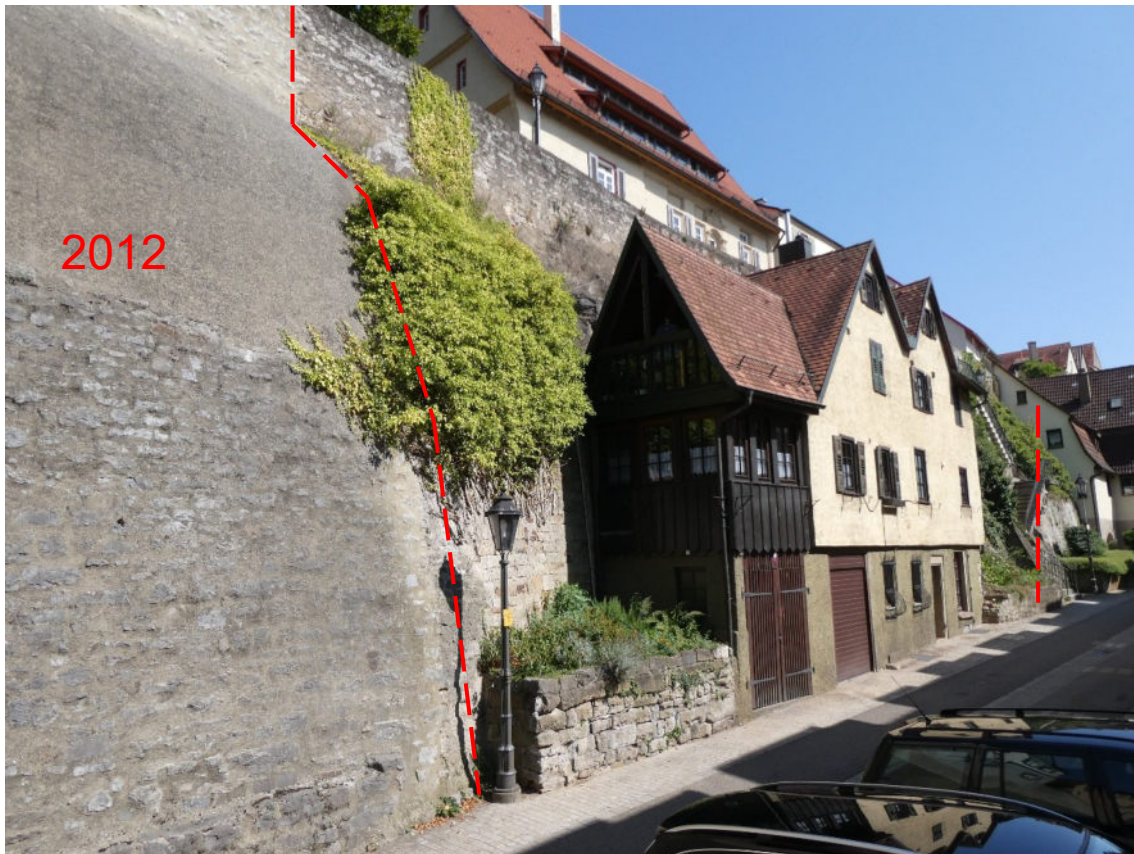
Ansicht des zu sanierenden Stadtmauerabschnitts im Bereich Wohnhauses Bügelestorstraße 3; links im Bild: Sanierungsabschnitt aus dem Jahr 2012
